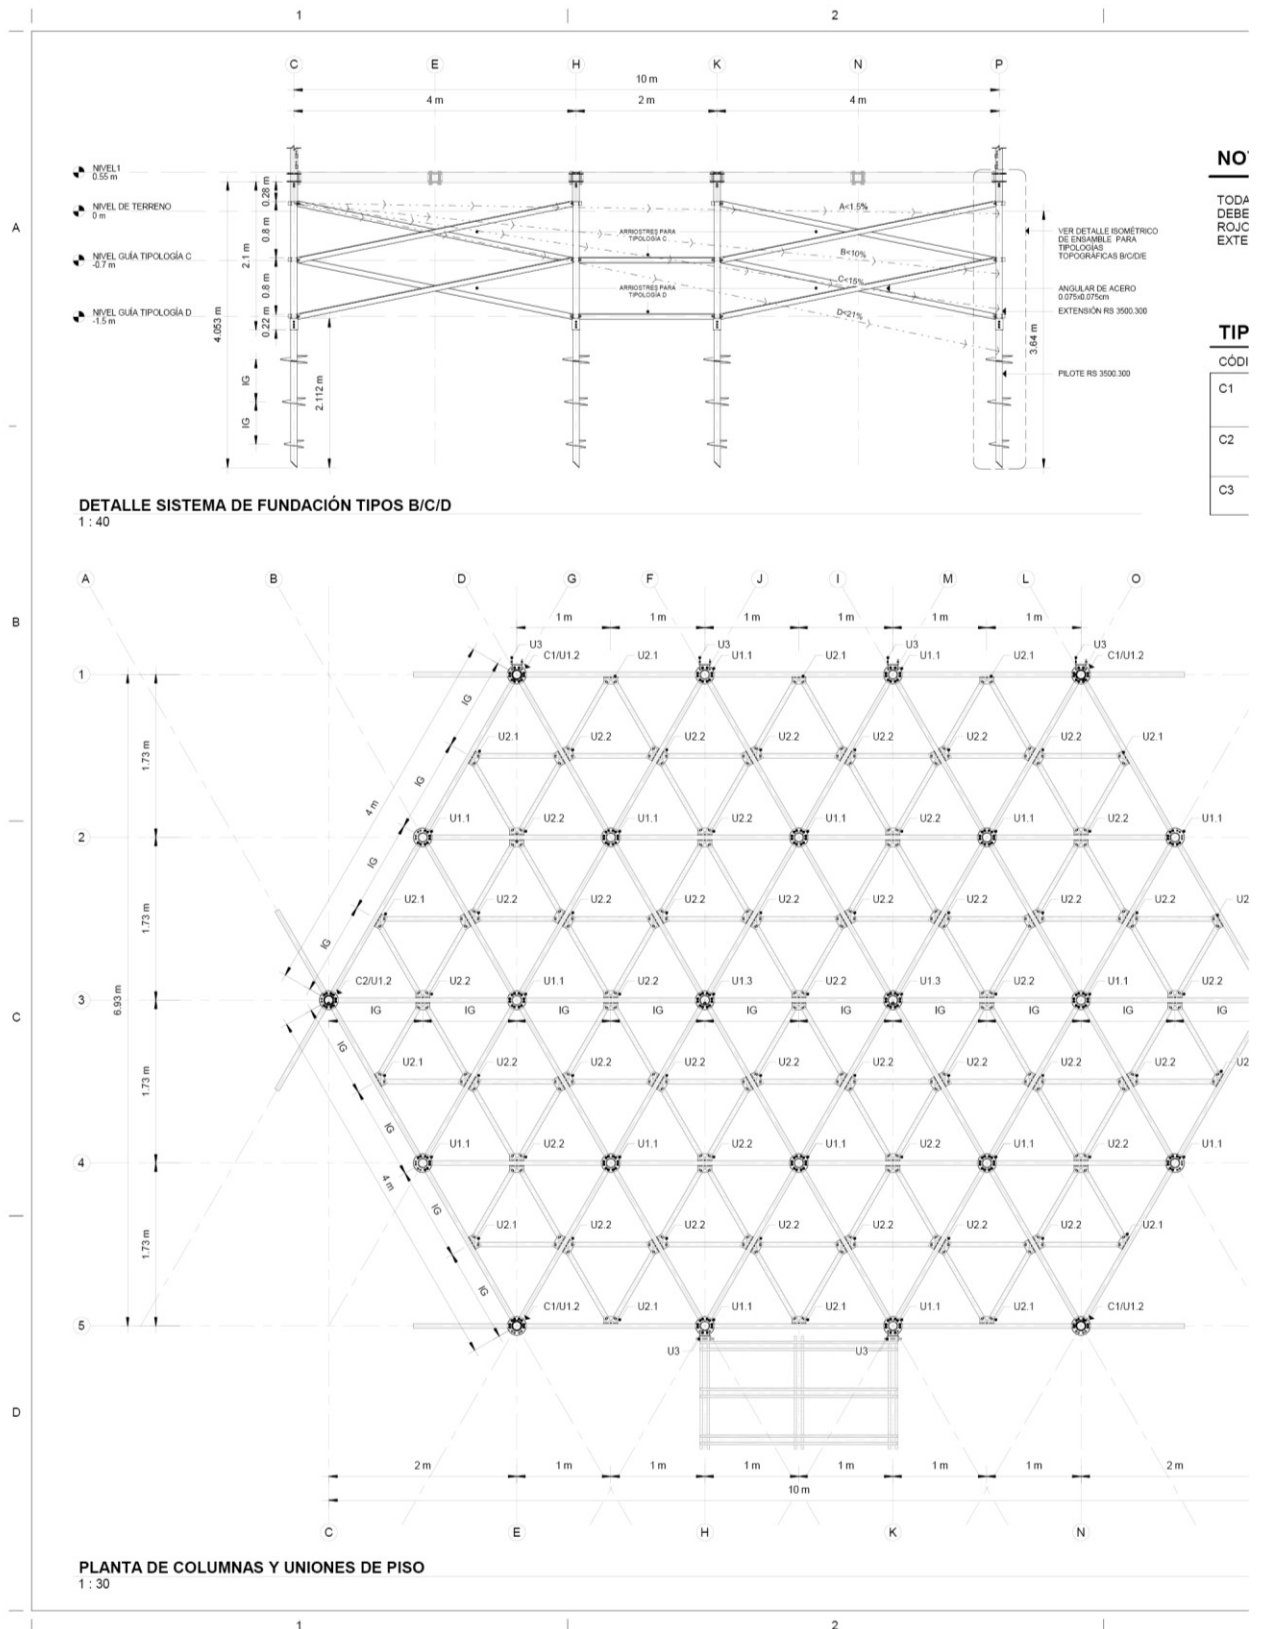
Lámina 11, planimetría de tipología B.<sup>320</sup>
